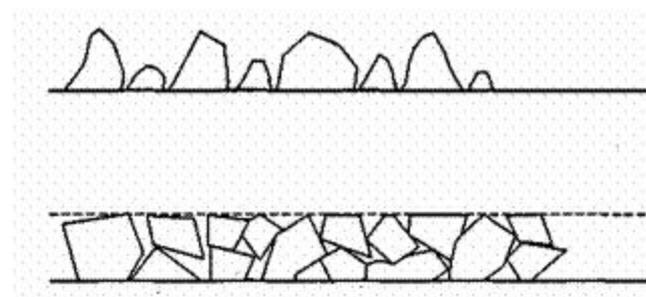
Поверхность твердого покрытия: а — поверхностная обработка; б — слой «новочип»
